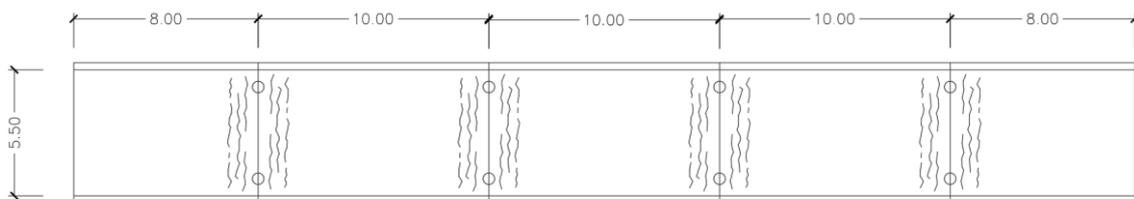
Fisuras en la carpeta de rodadura. Vista superior del tablero.
